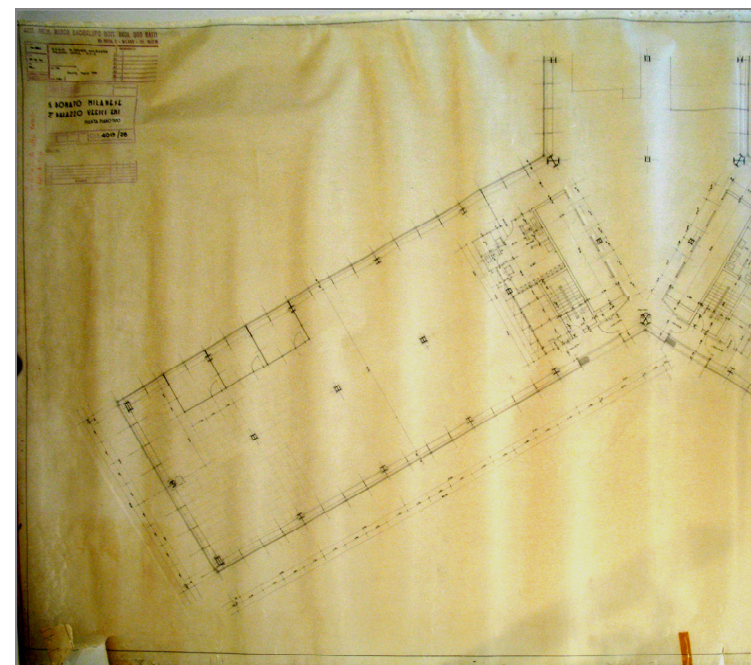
stralcio pianta piano tipo (fonte CSAC – stralcio tav. 12, archivio n. 234-1)
